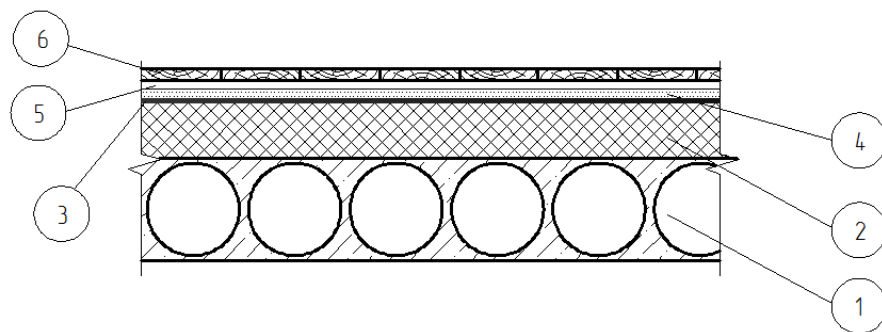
Схема до теплотехнічного розрахунку перекриття над підвалом:
